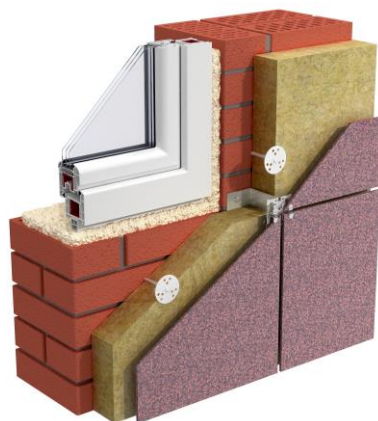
Навесной вентилируемый фасад ТН-ФАСАД Вент
